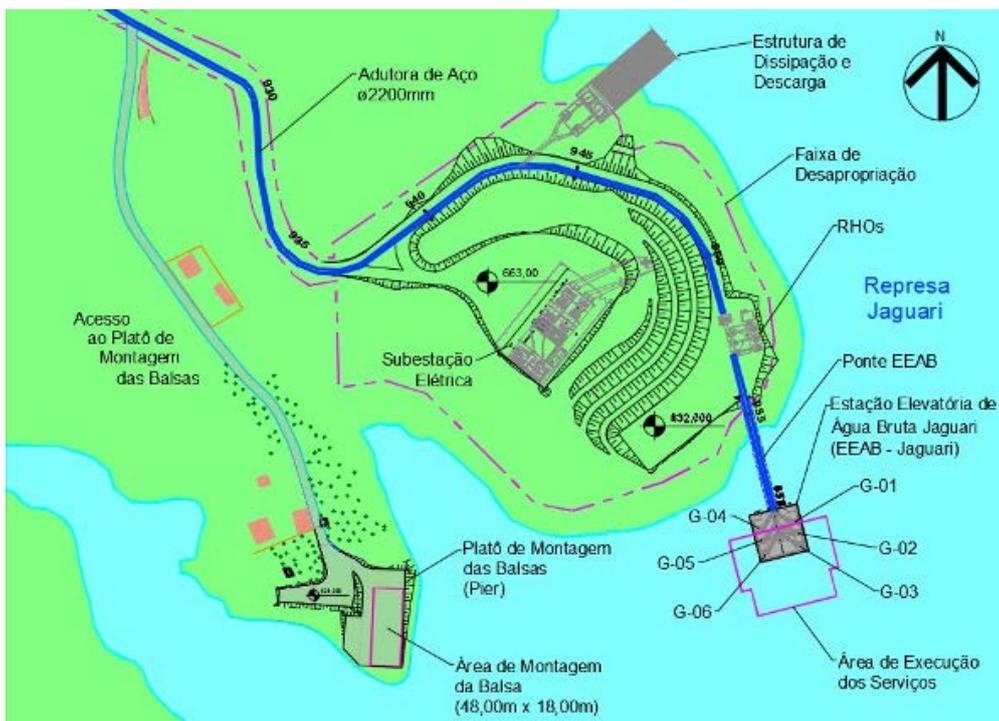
Planta esquemática da EEAB Jaguari, Subestação Elétrica e Dissipação
